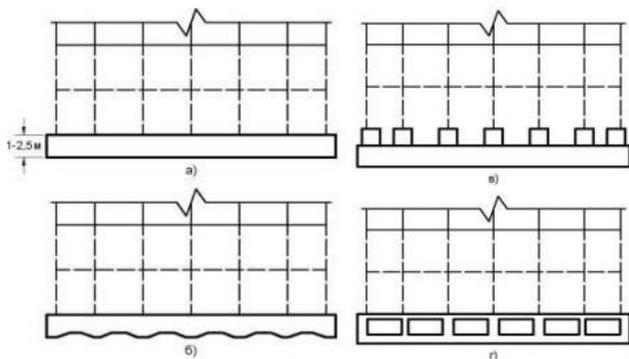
Конструкции единой монолитной железобетонной плиты.
